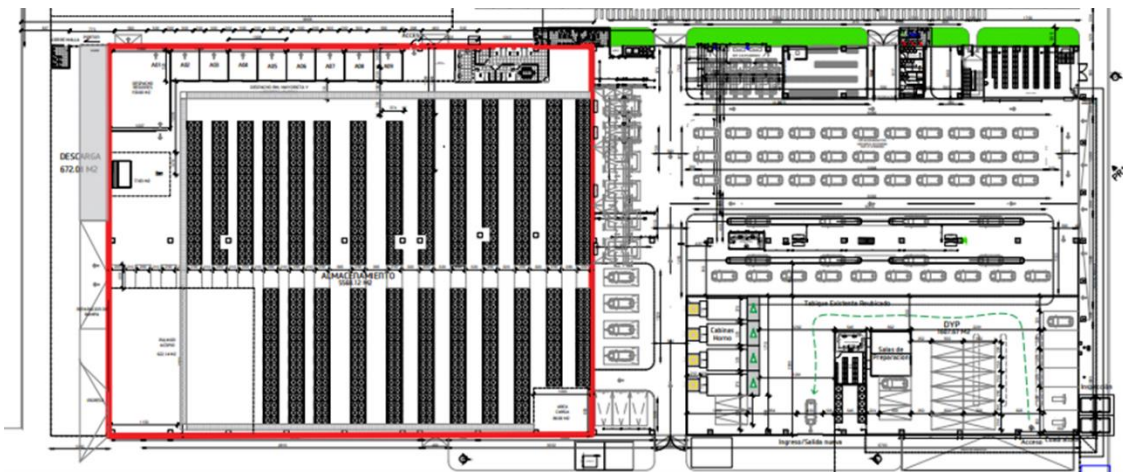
"Layout Galpón implementado el proyecto". Fuente Propia.
